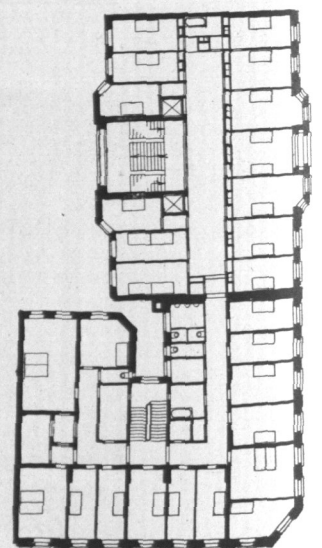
Hotel Berliner Hof, Obergeschoß, Grundriß.
